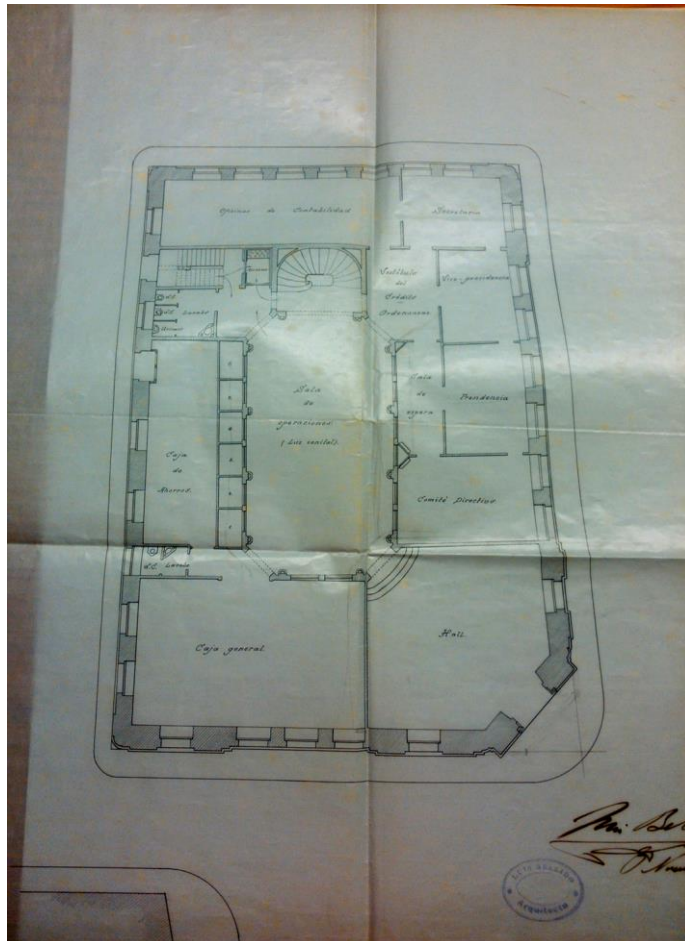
Planta del edificio del Crédito Industrial Gijonés. Arquitecto Luis Bellido. Año 1902. Archivo Municipal de Gijón
